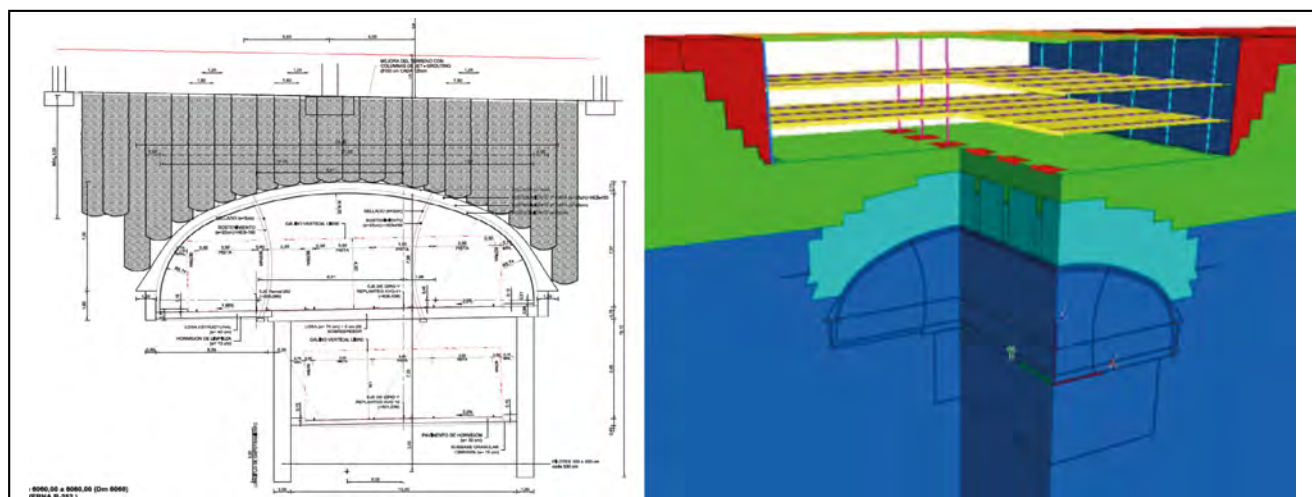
Tratamiento del terreno con *jet grouting* bajo el aparcamiento subterráneo y modelo de cálculo.
